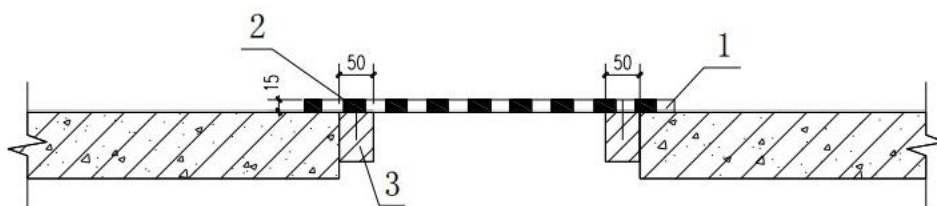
洞口盖板防护做法剖面示意图(单位: mm)
